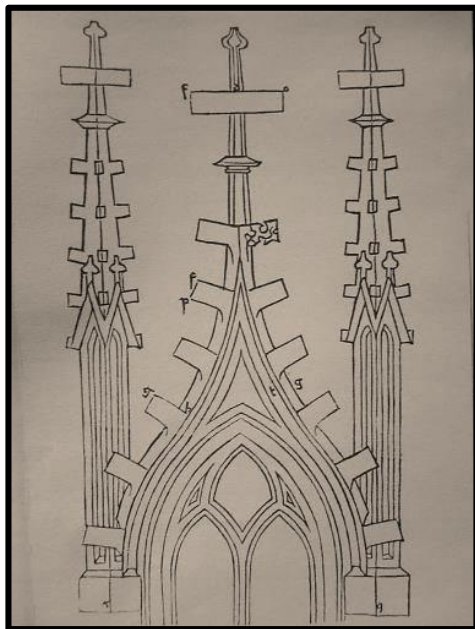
Skicář, Villard de Honecourt, 13.stol.
